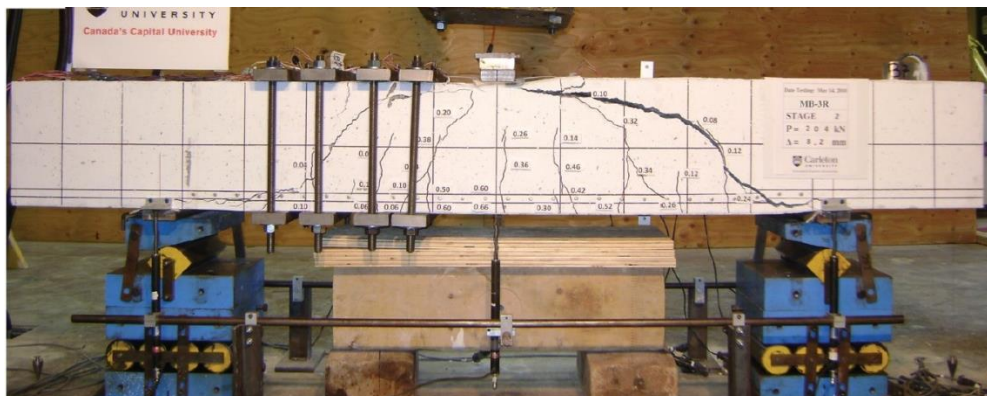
Rupture par cisaillement d'une poutre, illustration des fissures de cisaillement et de flexion, tiré de Khaja et Sherwood, 2013 [13].
